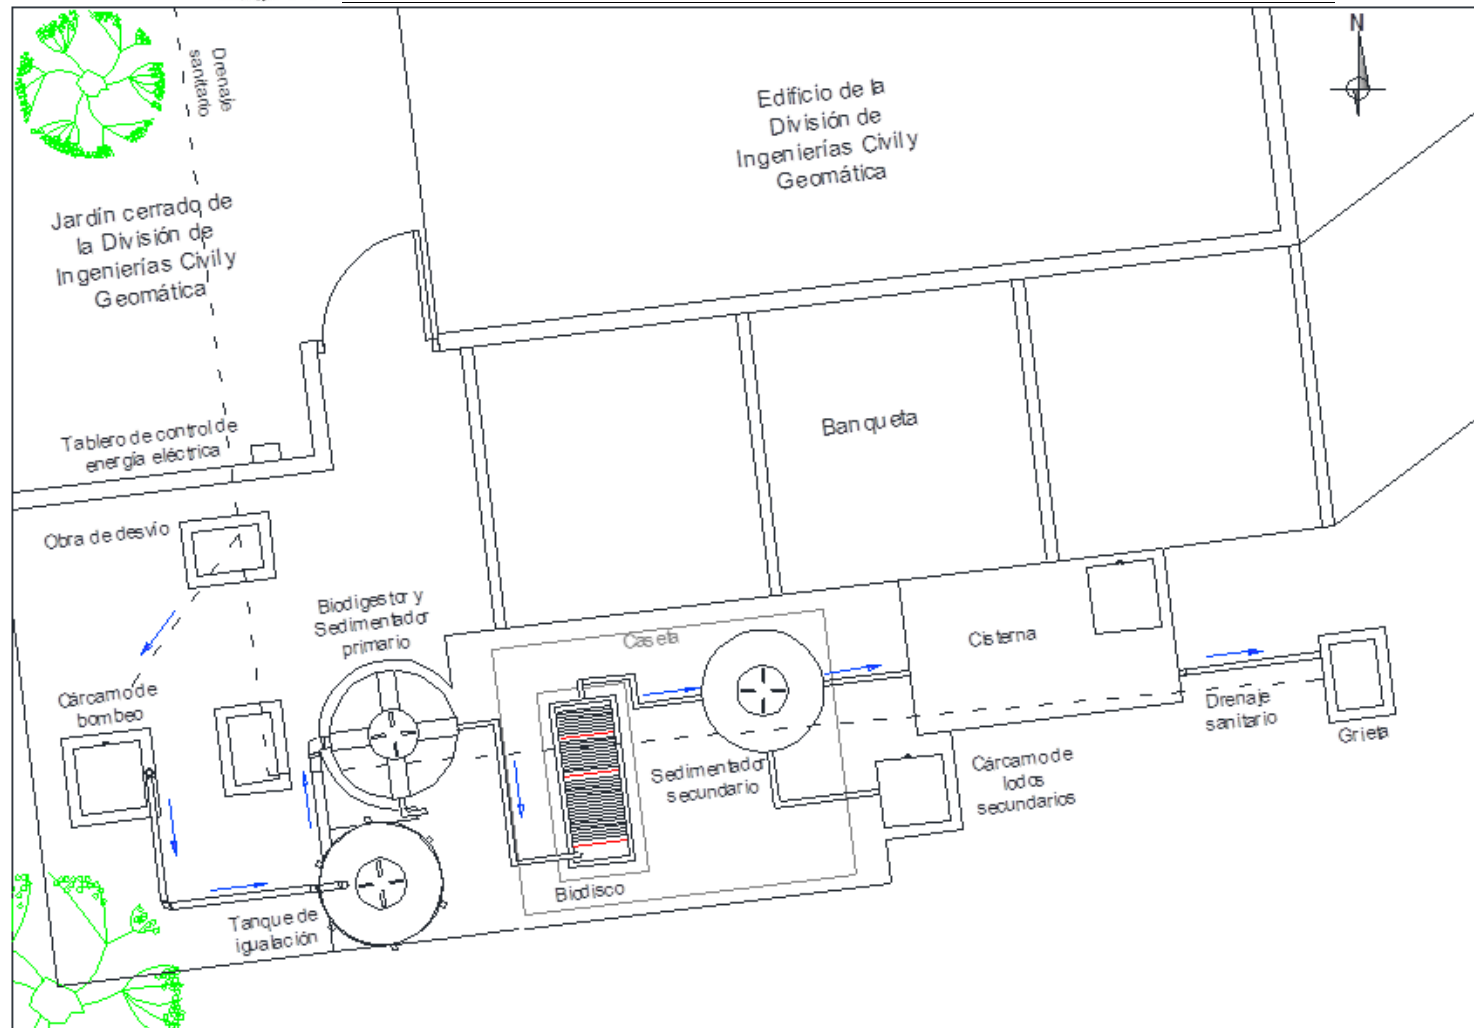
Vista de planta de los componentes de la planta y el sentido de flujo
